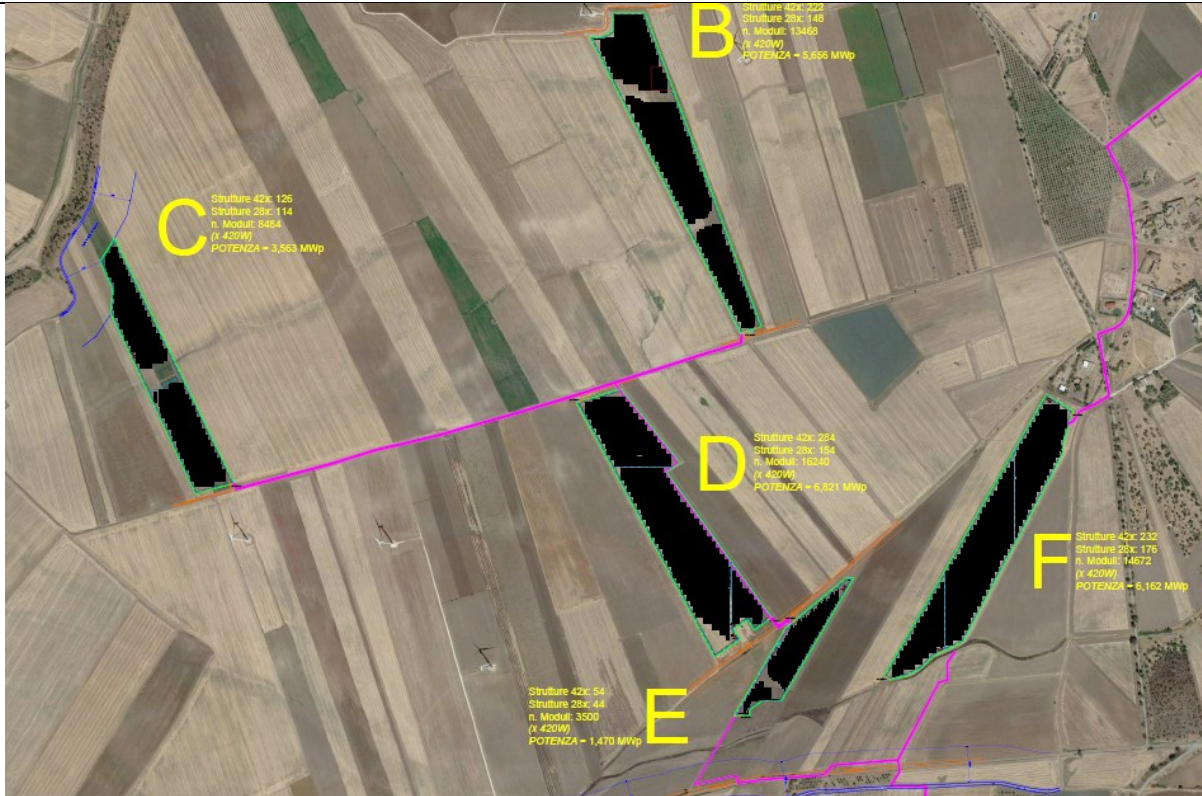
Layout di impianto dell’Area B-C-D-E e F
